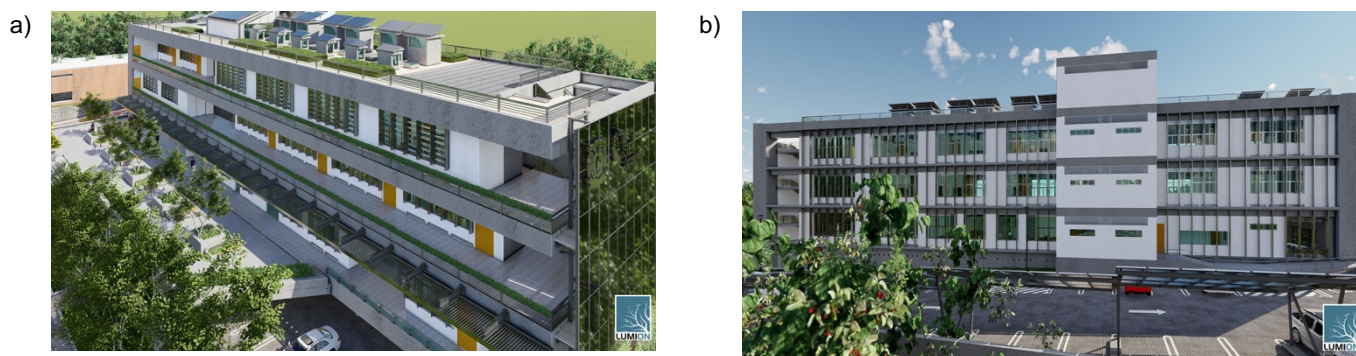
Fachadas: a) sur y b) norte., se observan los muros y azotea de color exterior blanco.
